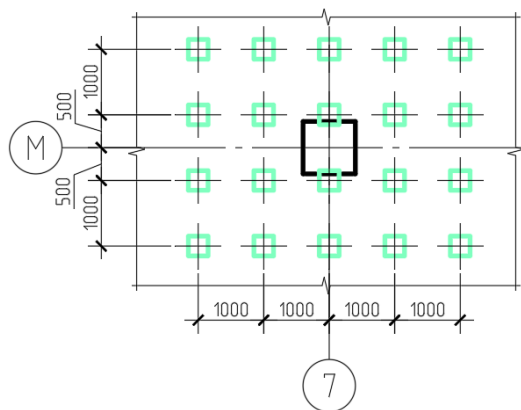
Схема расположения свай под фрагмент плитного фундамента
